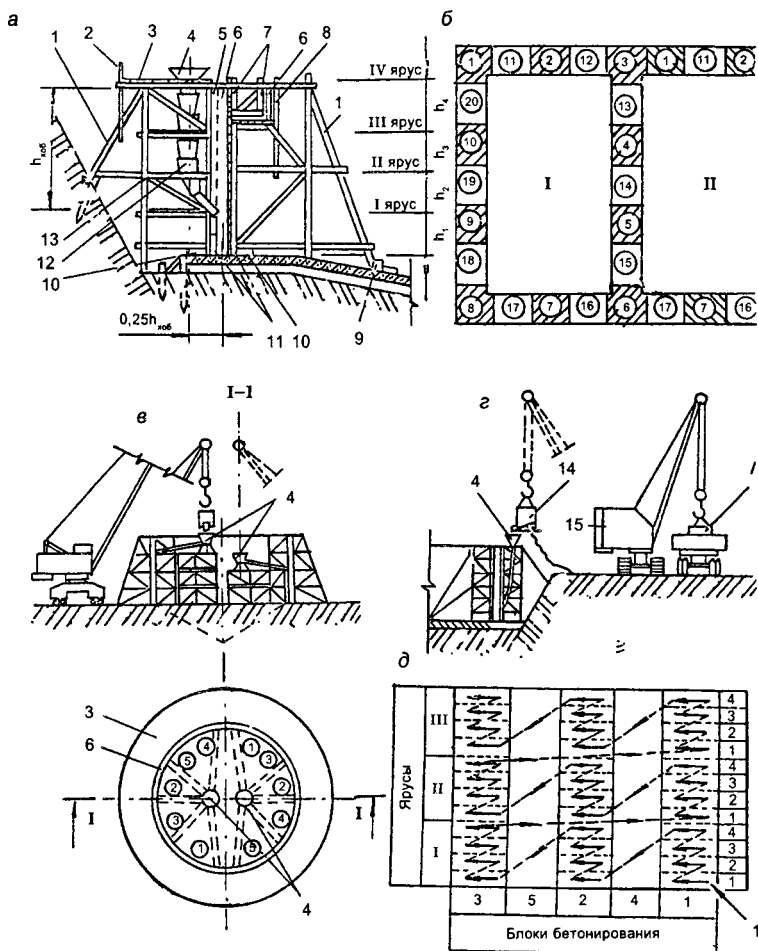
Бетонирование стен емкостных сооружений в щитовой опалубке:
